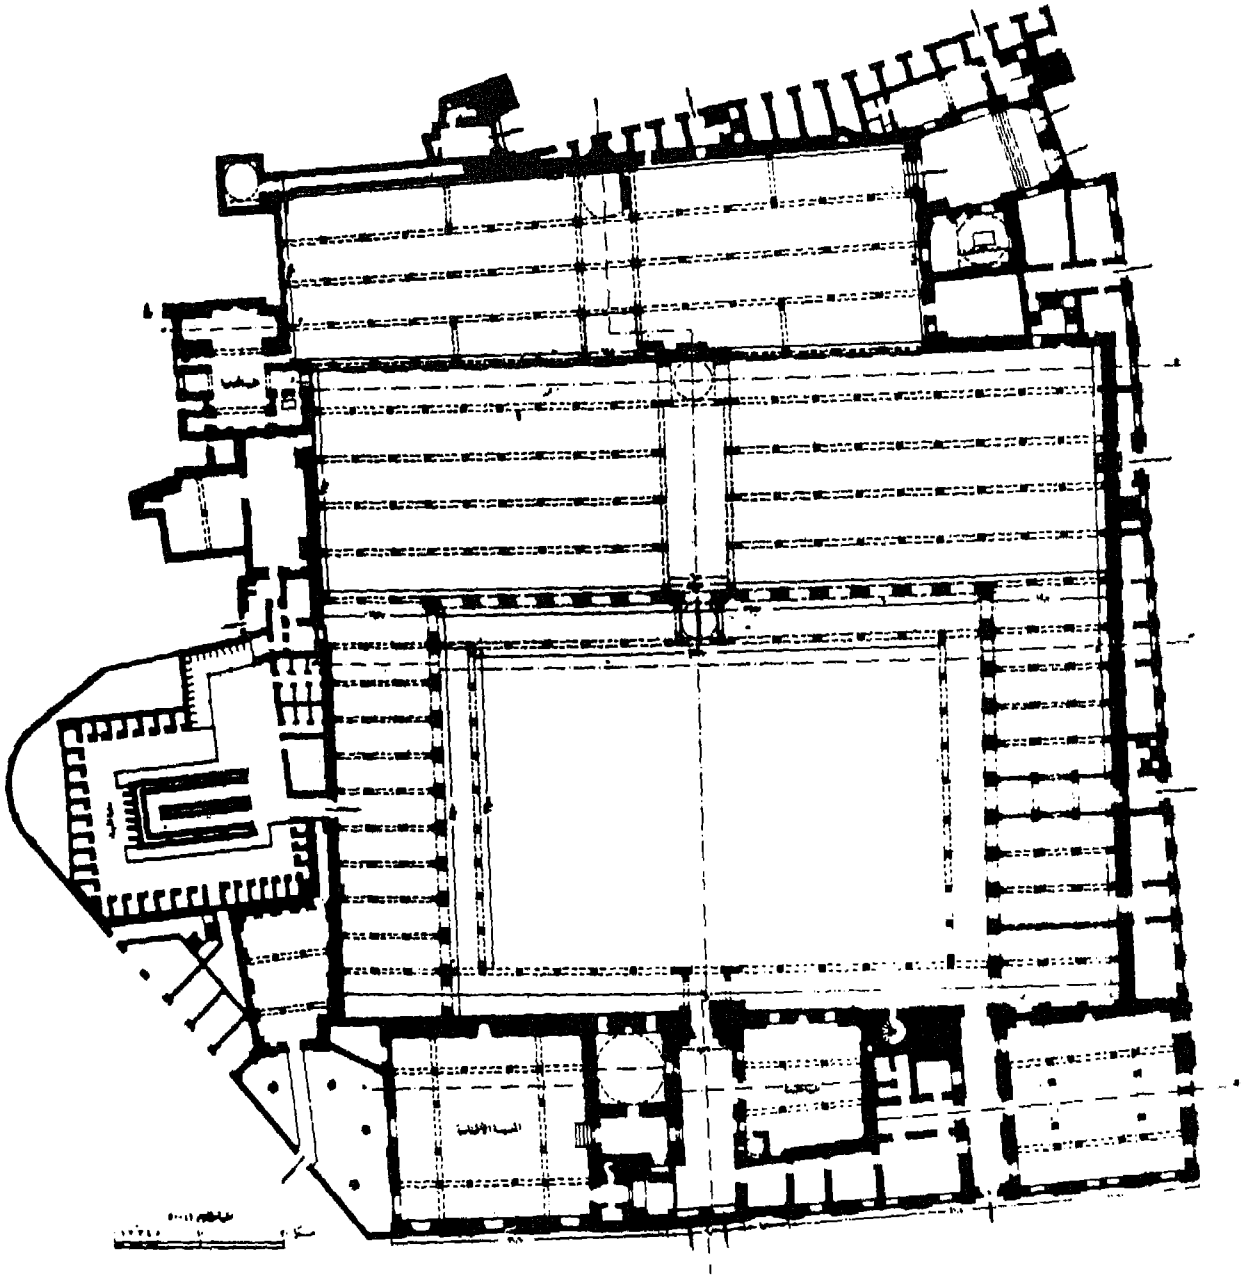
مسقط أفقى لمسجد سامرا
